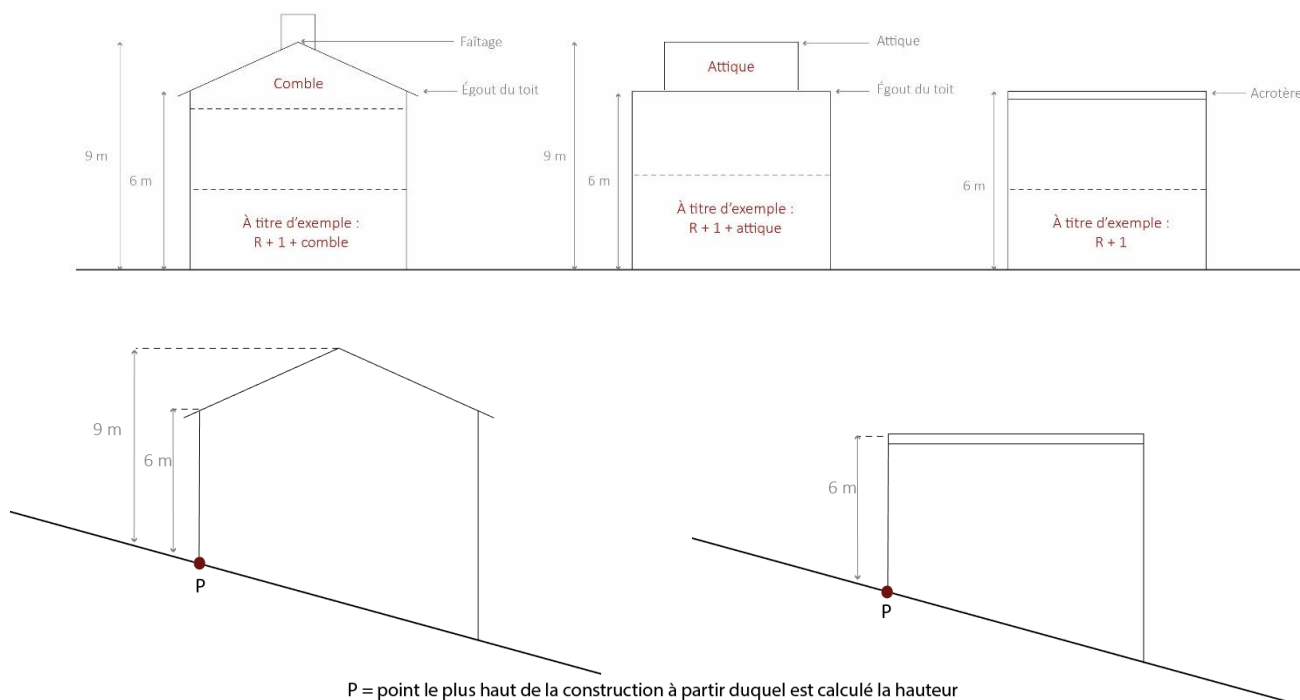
\_ Hauteur maximale autorisée dans la zone UC
